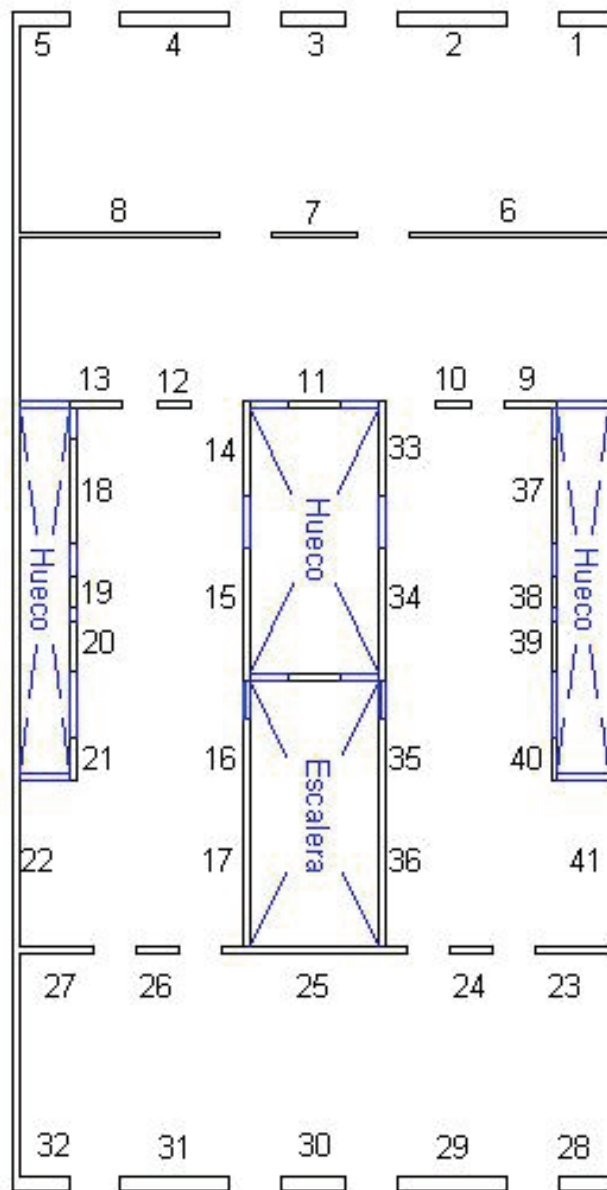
Muros de planta tipo dividido en paños portantes.
